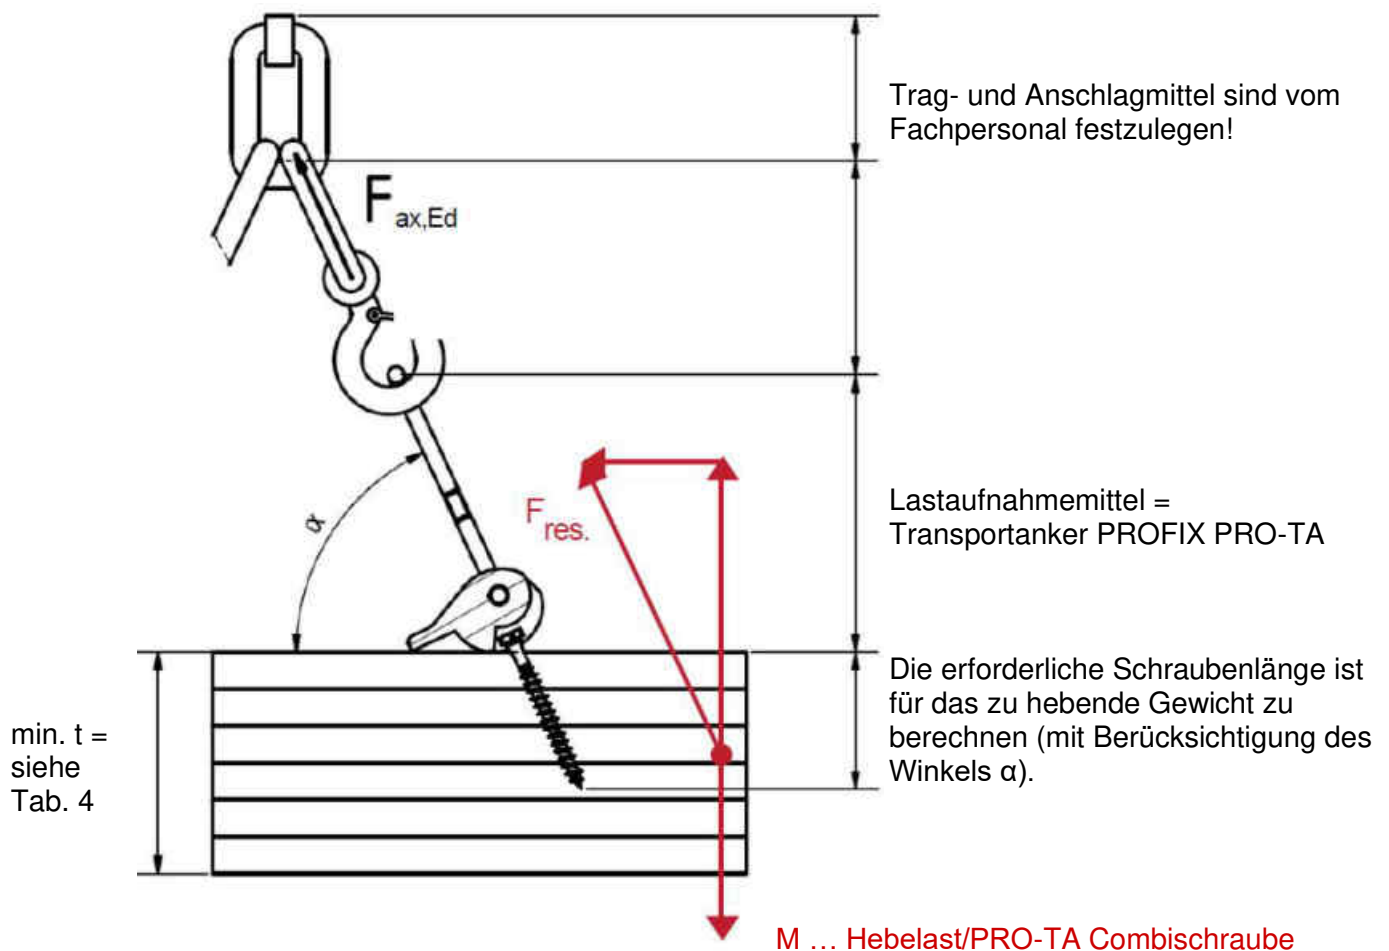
Axialzug-Belastung der PROFIX PRO-TA Schraube
